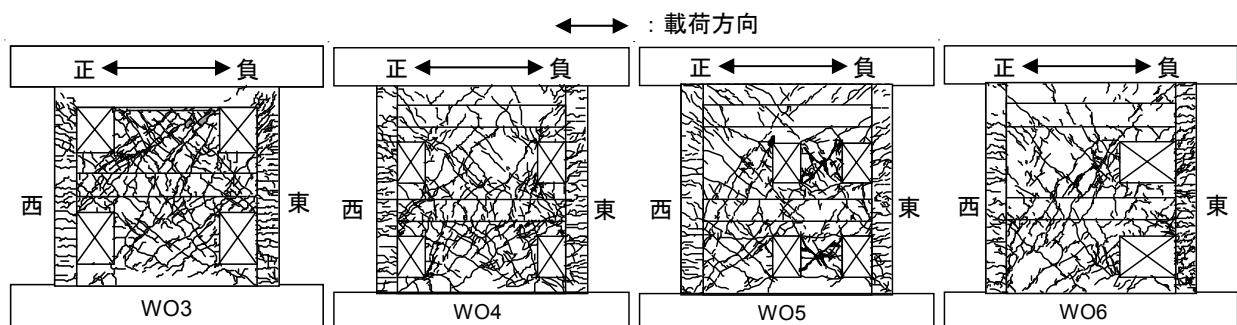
ひび割れ破壊状況 ($R=1/133rad.$)
